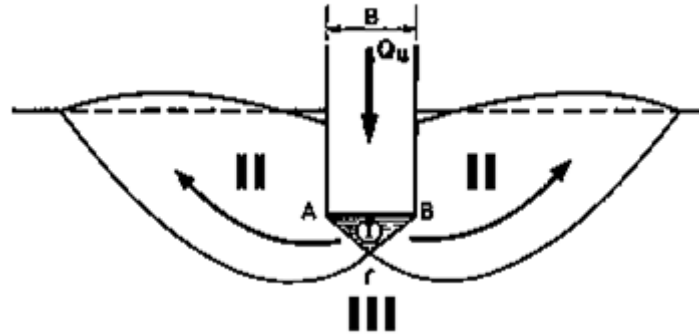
Schéma de rupture d'une fondation superficielle.
